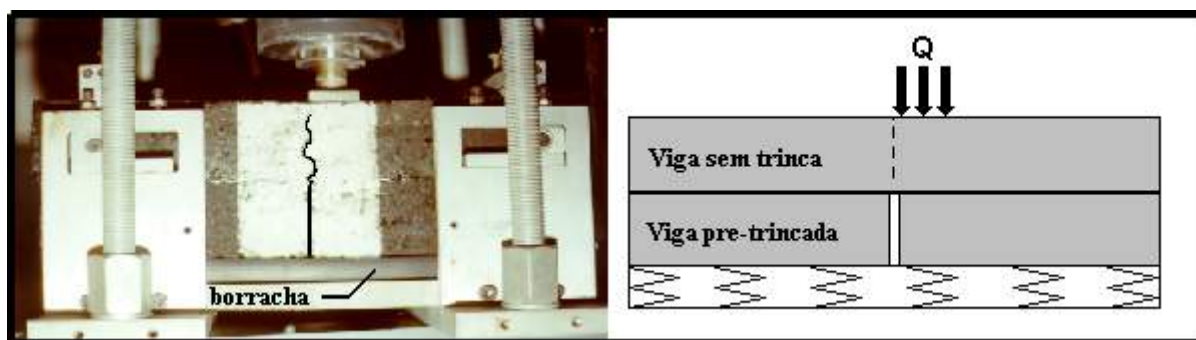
Propagação da trinca na posição cisalhante nas vigas convencionais.
